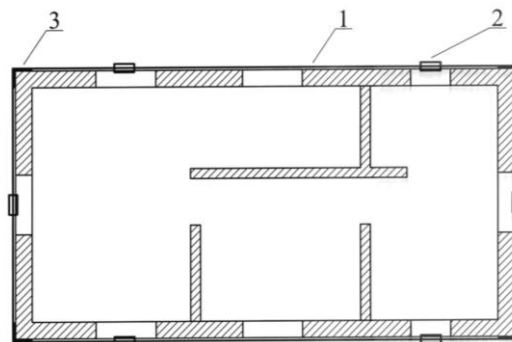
Восстановление пространственной жесткости (устойчивости) здания стальными поясами, расположенными в уровне перекрытий: 1 – стальные тяжи диаметром 25-40 мм; 2 – стяжные муфты (талрепы); 3 – подкладки из стального уголка, предохраняющие кладку от смятия
